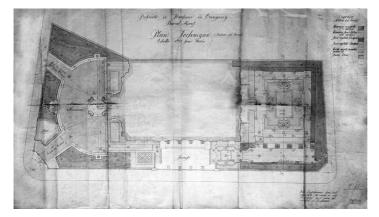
Palacio Errázuriz-Alvear. Planta del jardín. Fuente: MNAD.
